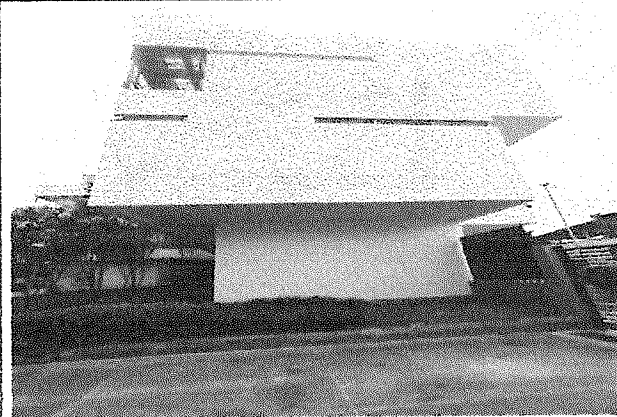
ESTACION SUR (filtraciones fachadas y cubiertas)
